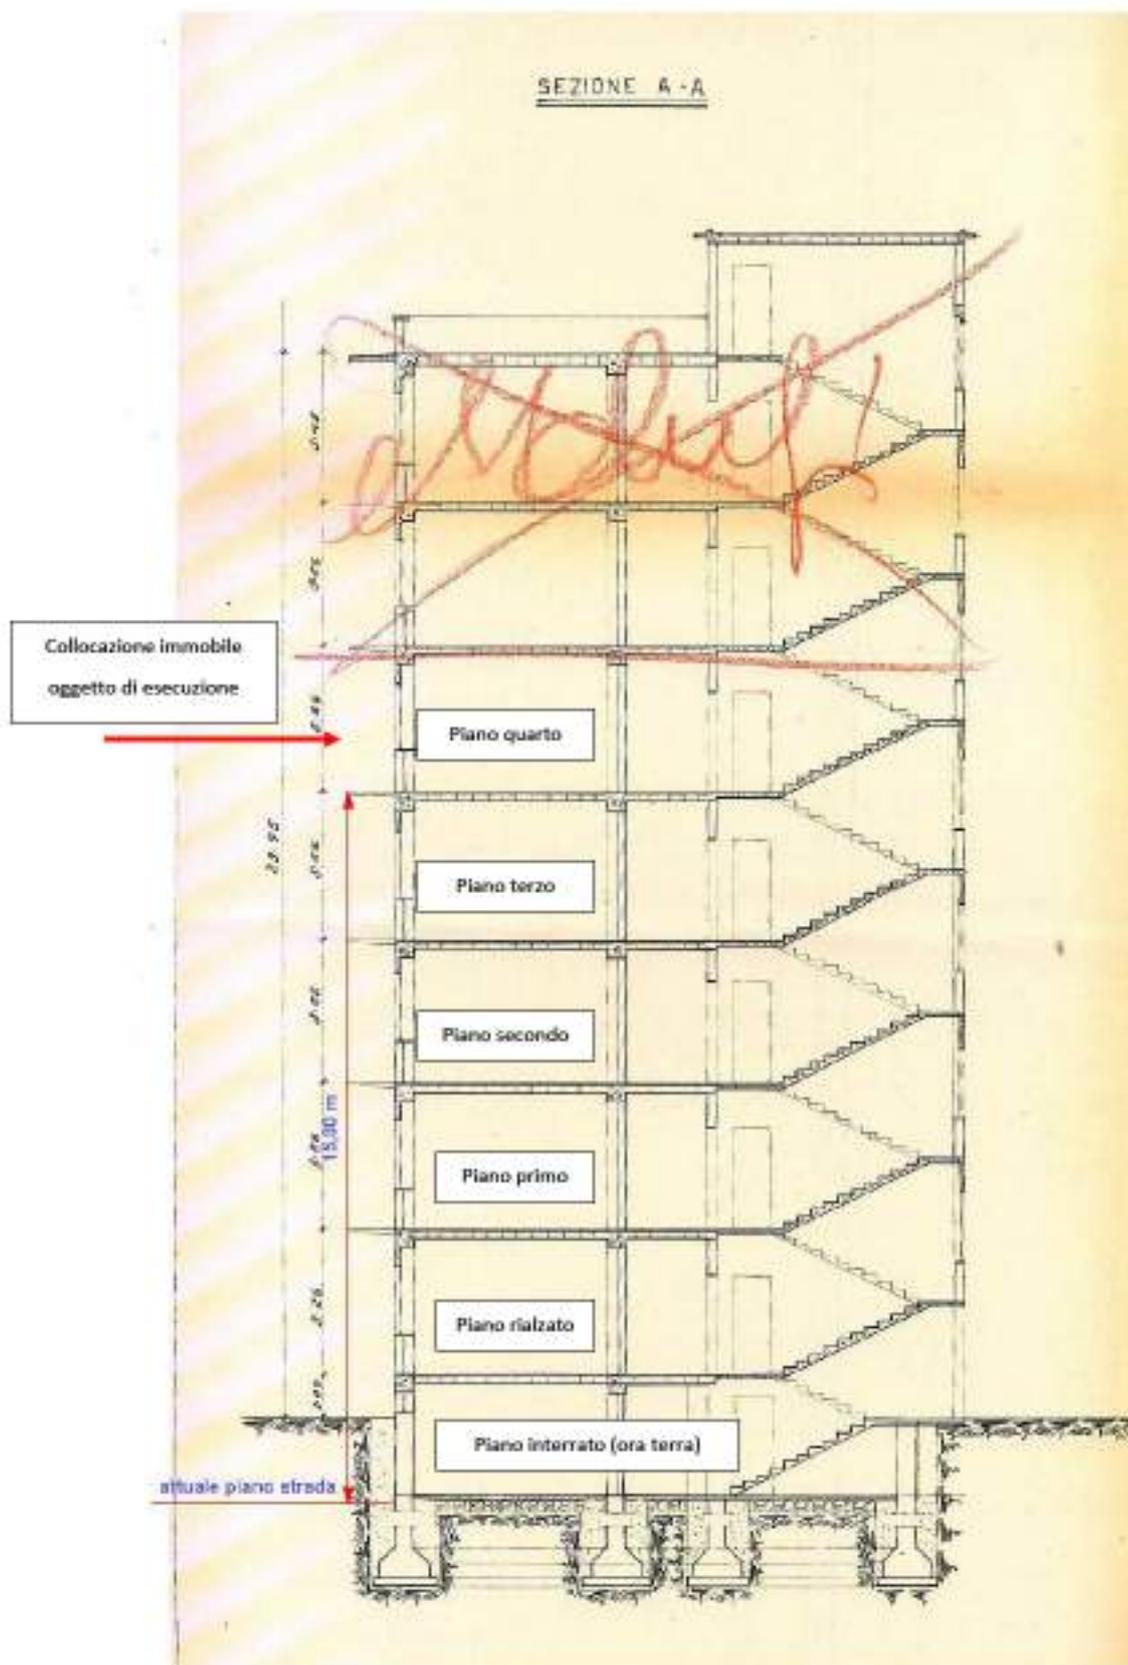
Sezione trasversale progetto edificio con indicati i piani.
